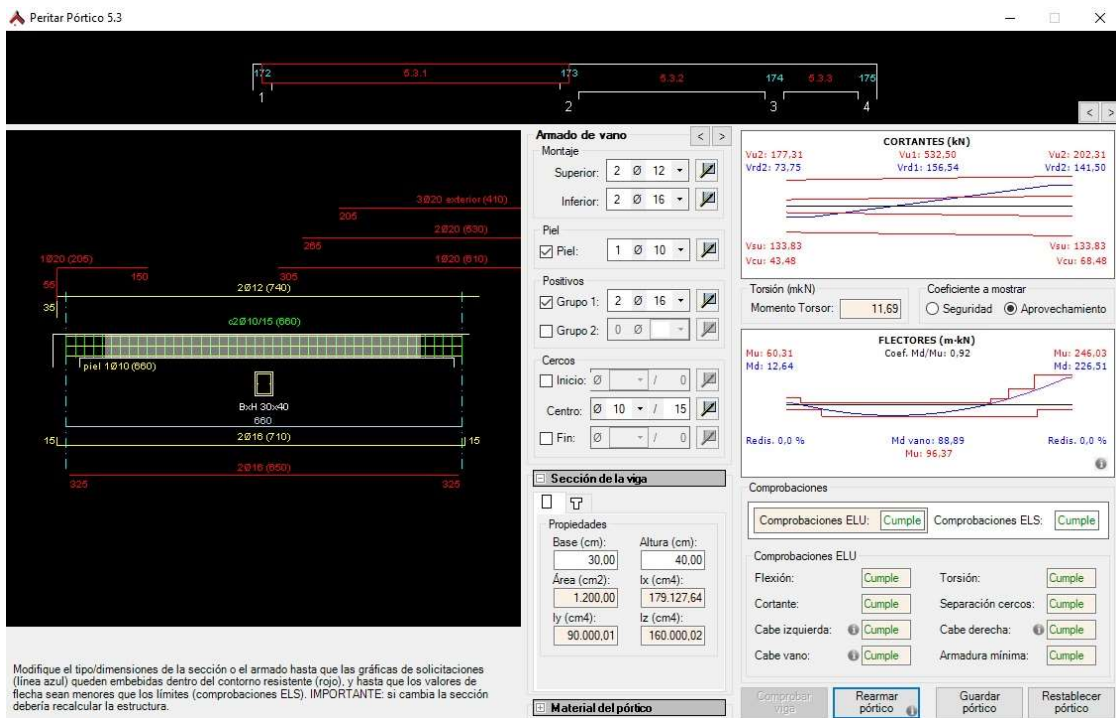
Optimización de la viga 5.3.2 de la estructura proyectada
